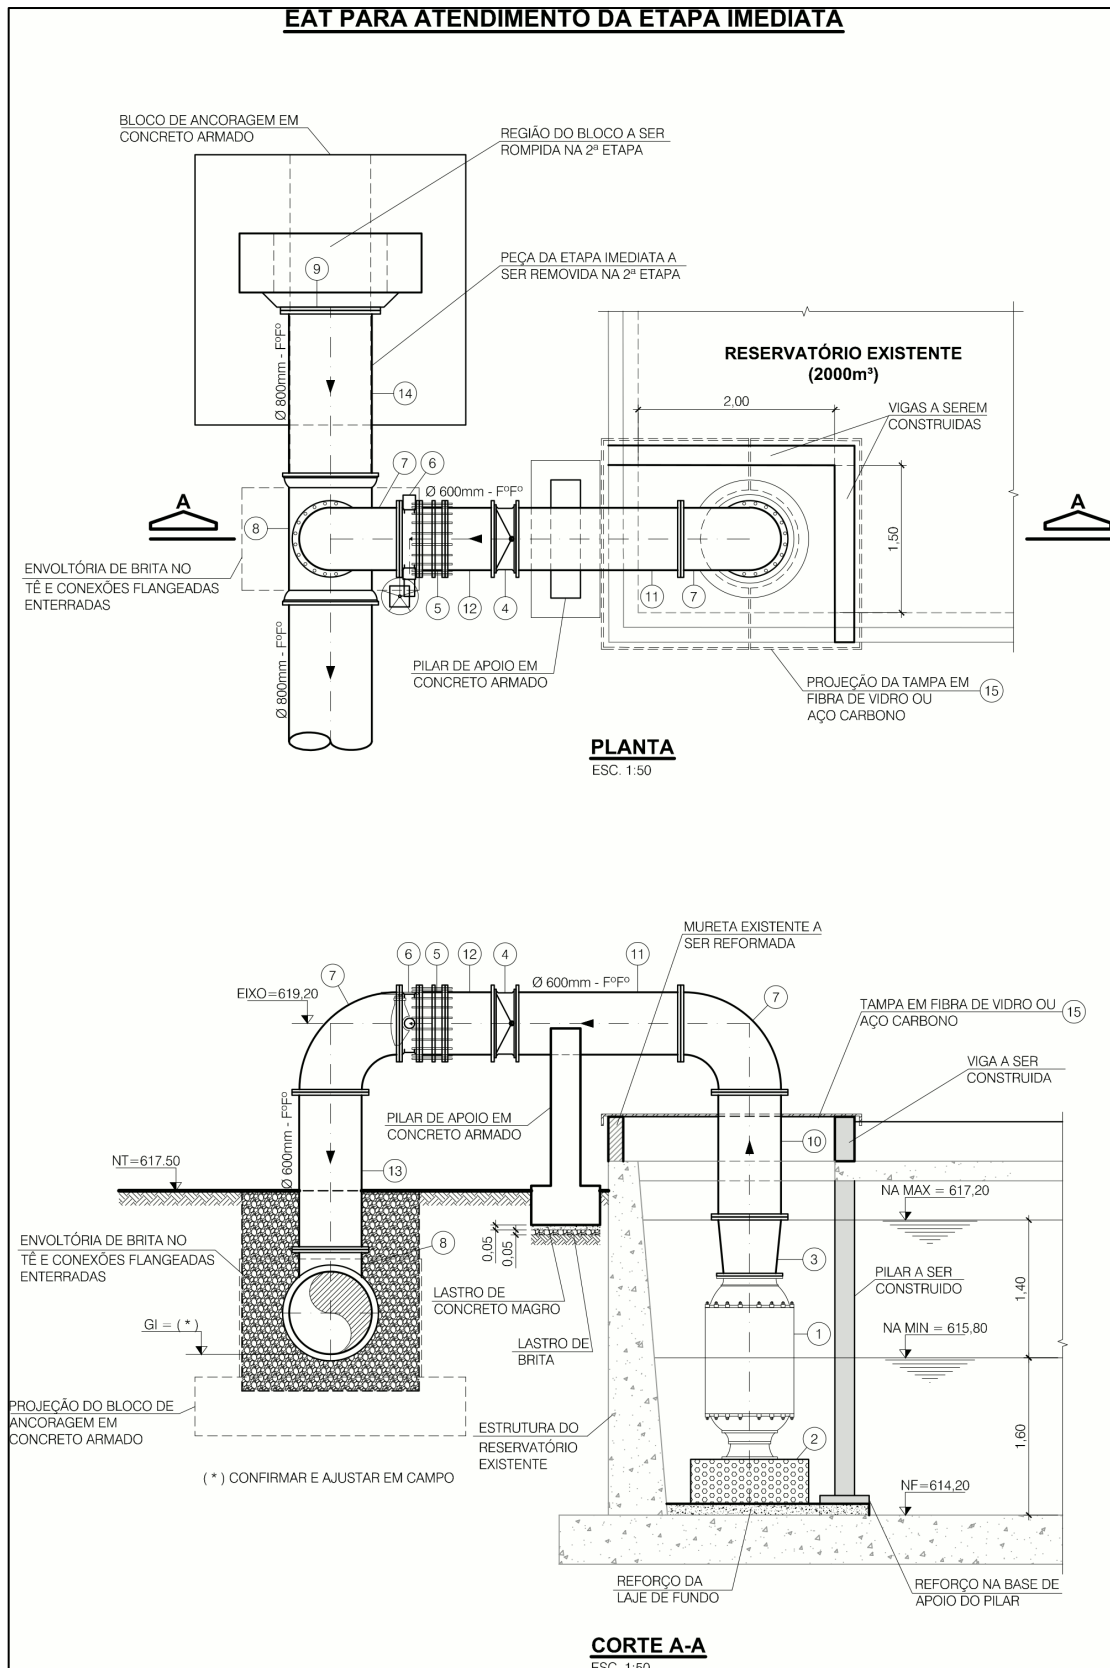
Planta e Corte da EAT 1ª Etapa.
